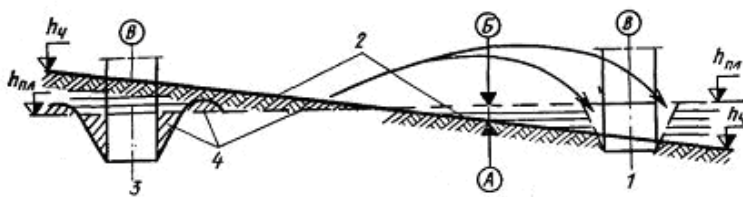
Разграничение вертикальной планировки: 1 — разработка котлована на участке планировочной насыпи; 2 — разработка грунта планировочной выемки с перемещением в насыпь; 3 — разработка котлована на участке планировочной выемки; 4 — засыпка пазух зарезервированным грунтом; А — профиль земли; Б — уровень планировки; В — подземная часть здания.
